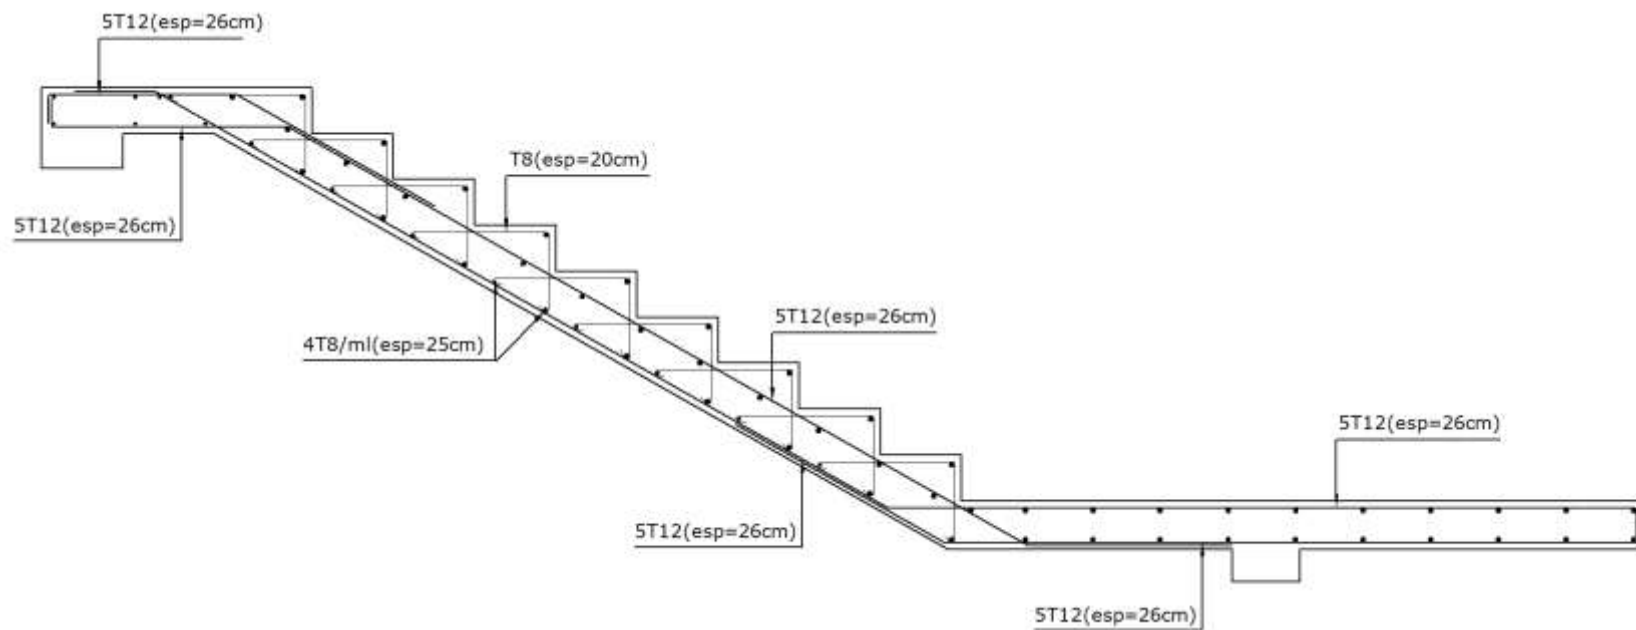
Ferrailage de l'escalier d'étage courant.
